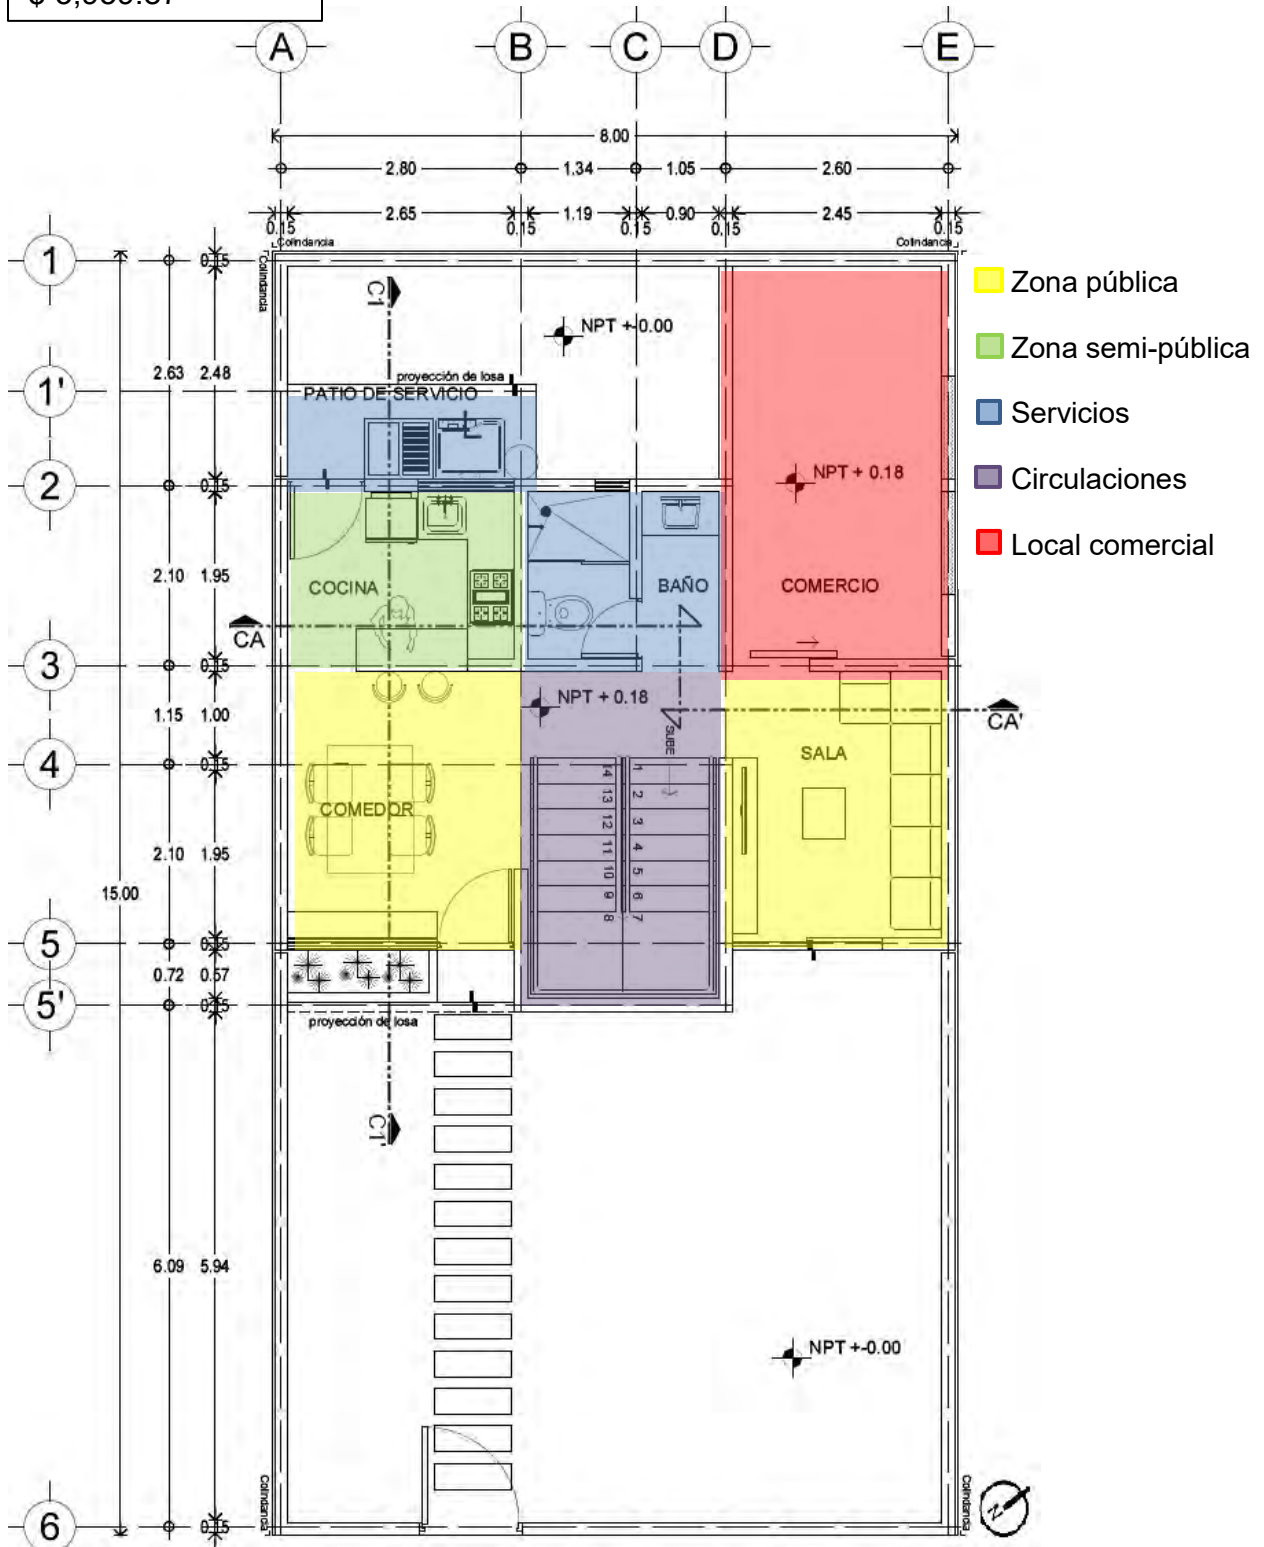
Planta arquitectónica de prototipo de vivienda A3. Tercera etapa, planta baja.
